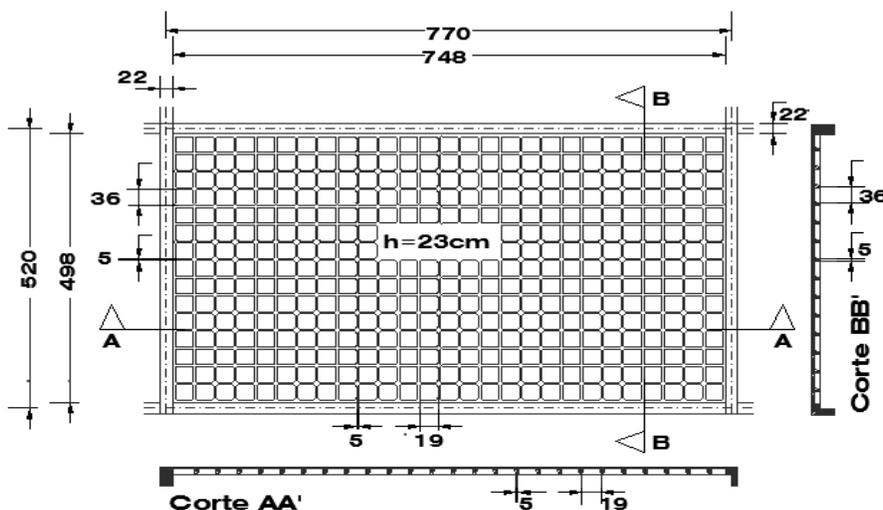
Exemplo de laje nervurada bidirecional: planta de fôrmas (Autor (2017)).
